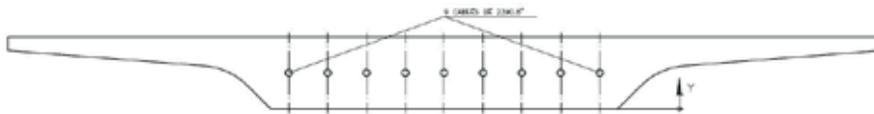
Sección tipo de pretensado en la estructura de la carretera SG-20
